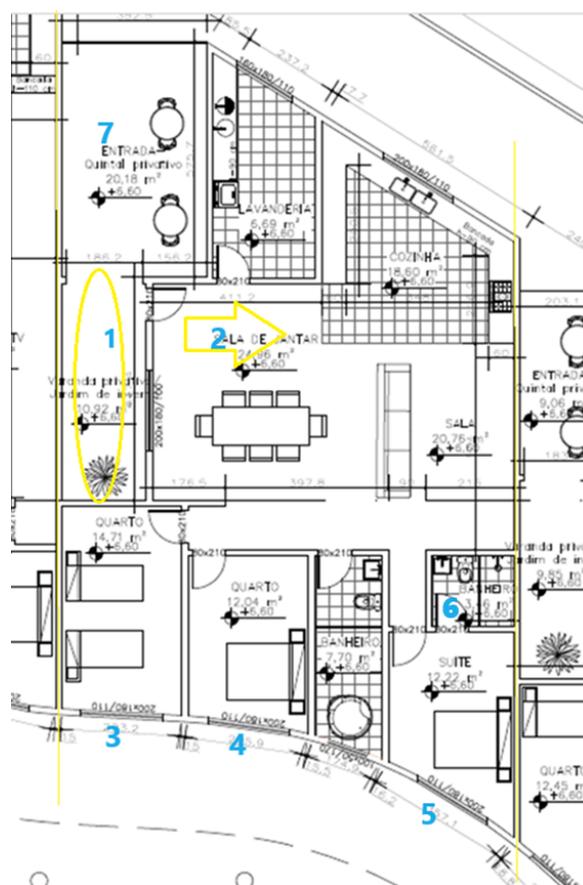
Planta baixa segundo e terceiro pavimento – apartamentos
